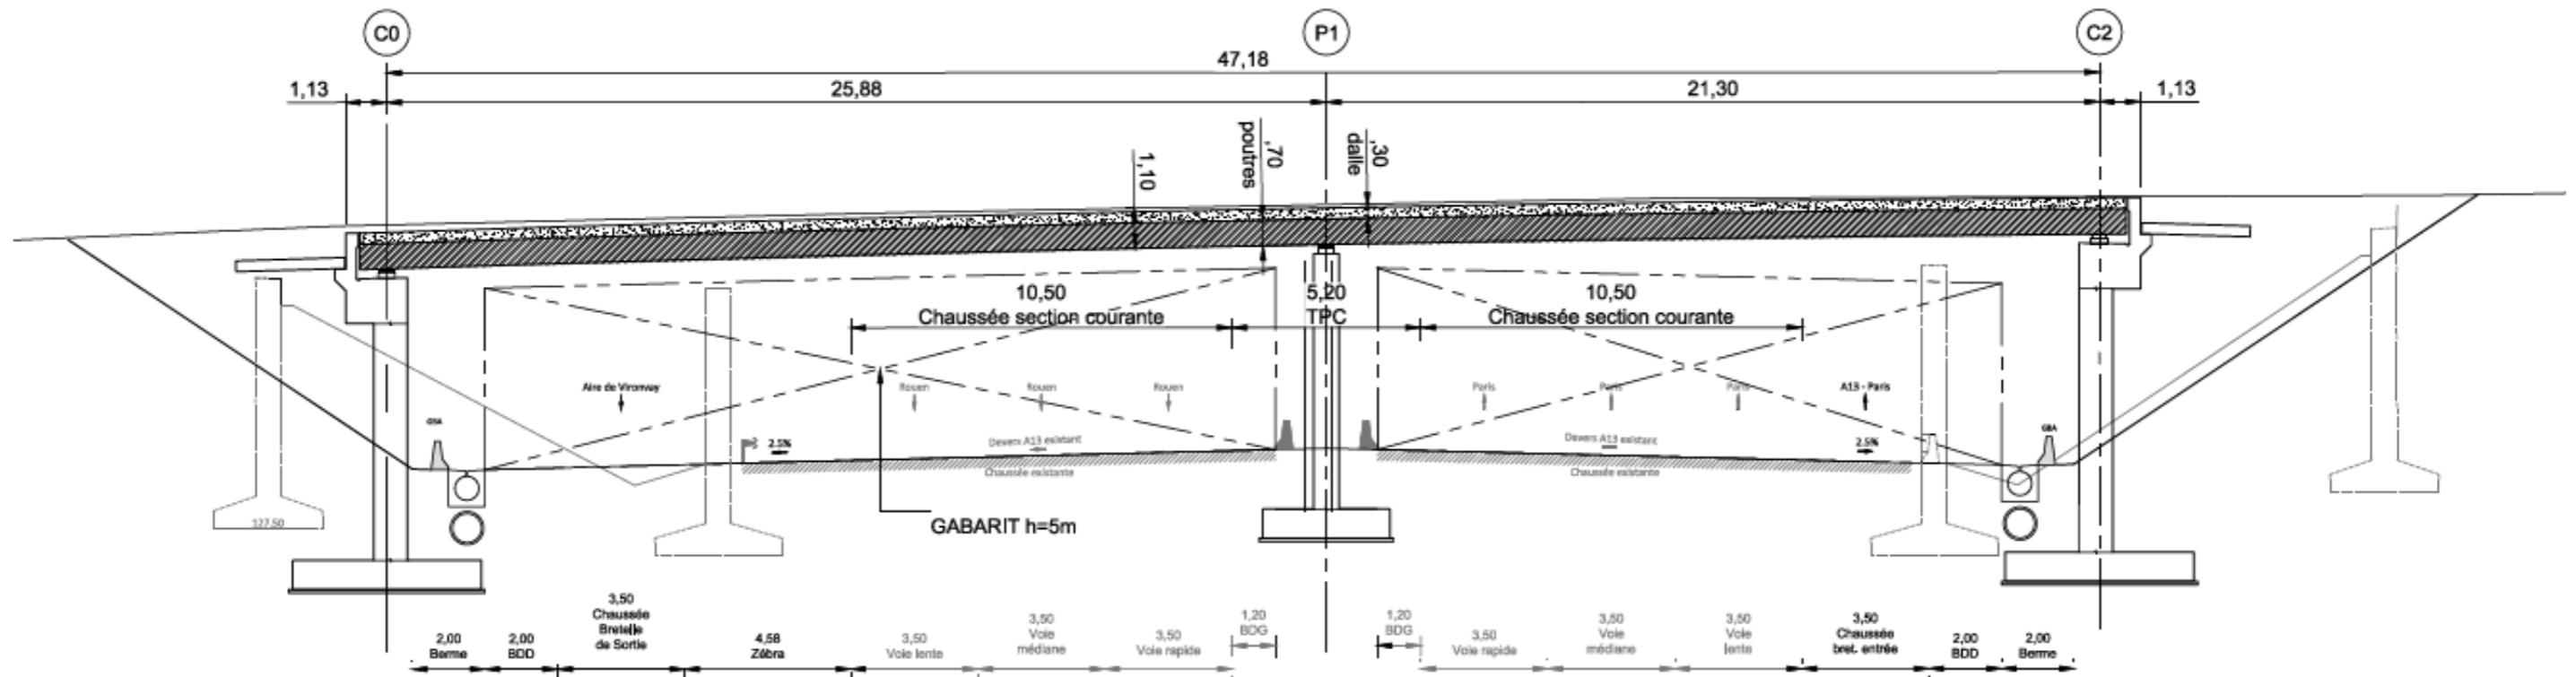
PROFIL EN TRAVERS DE LA SECTION COURANTE SOUS OUVRAGE D'ART
